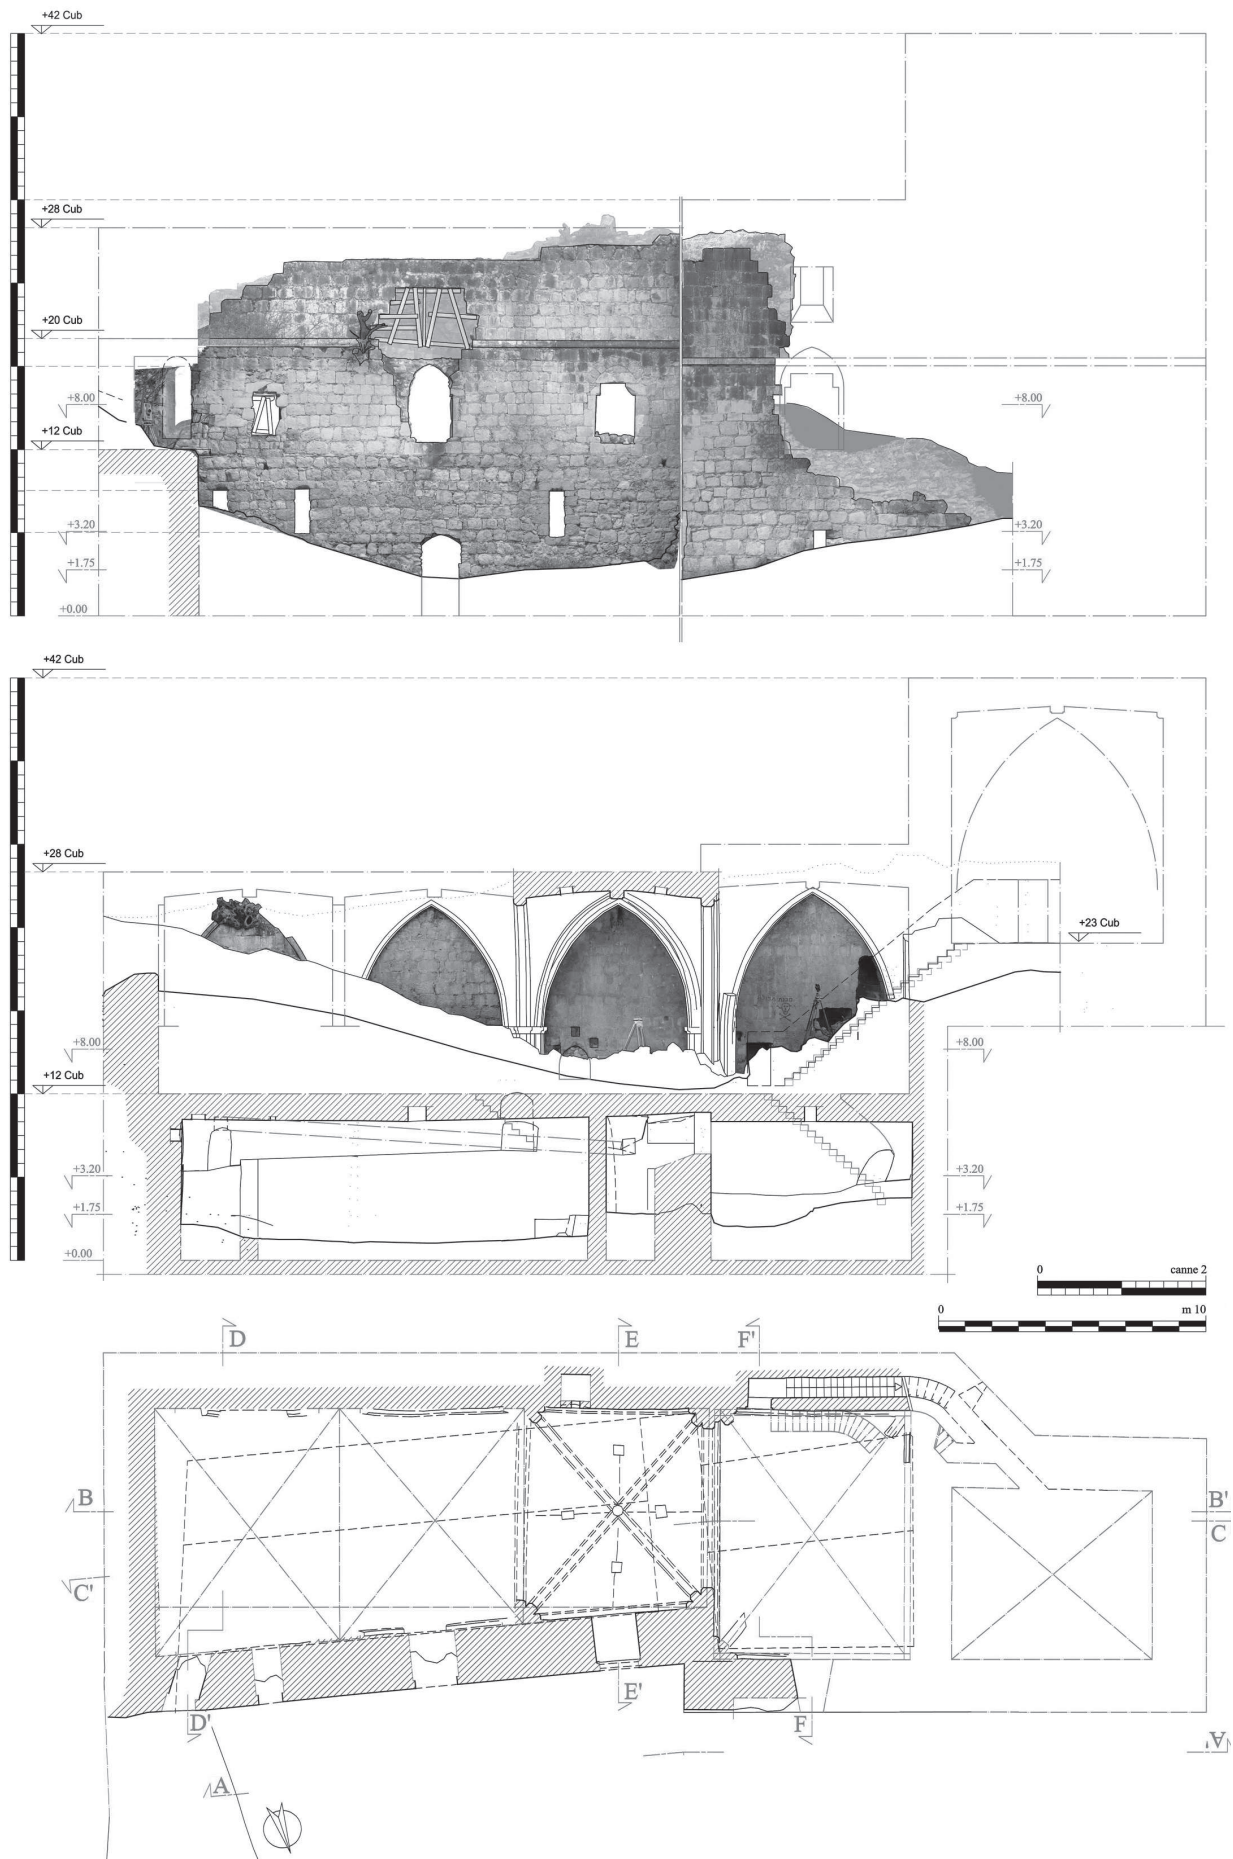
Castellum Novum, rilievo del 2010: pianta, prospetto e sezione con la ricostruzione geometrica dell'originale conformazione.
